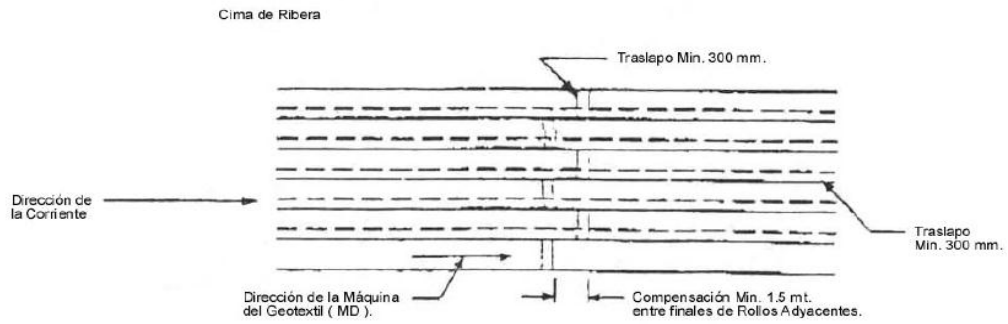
Esquema de Colocación de Geotextil para Protección de Cauces.
